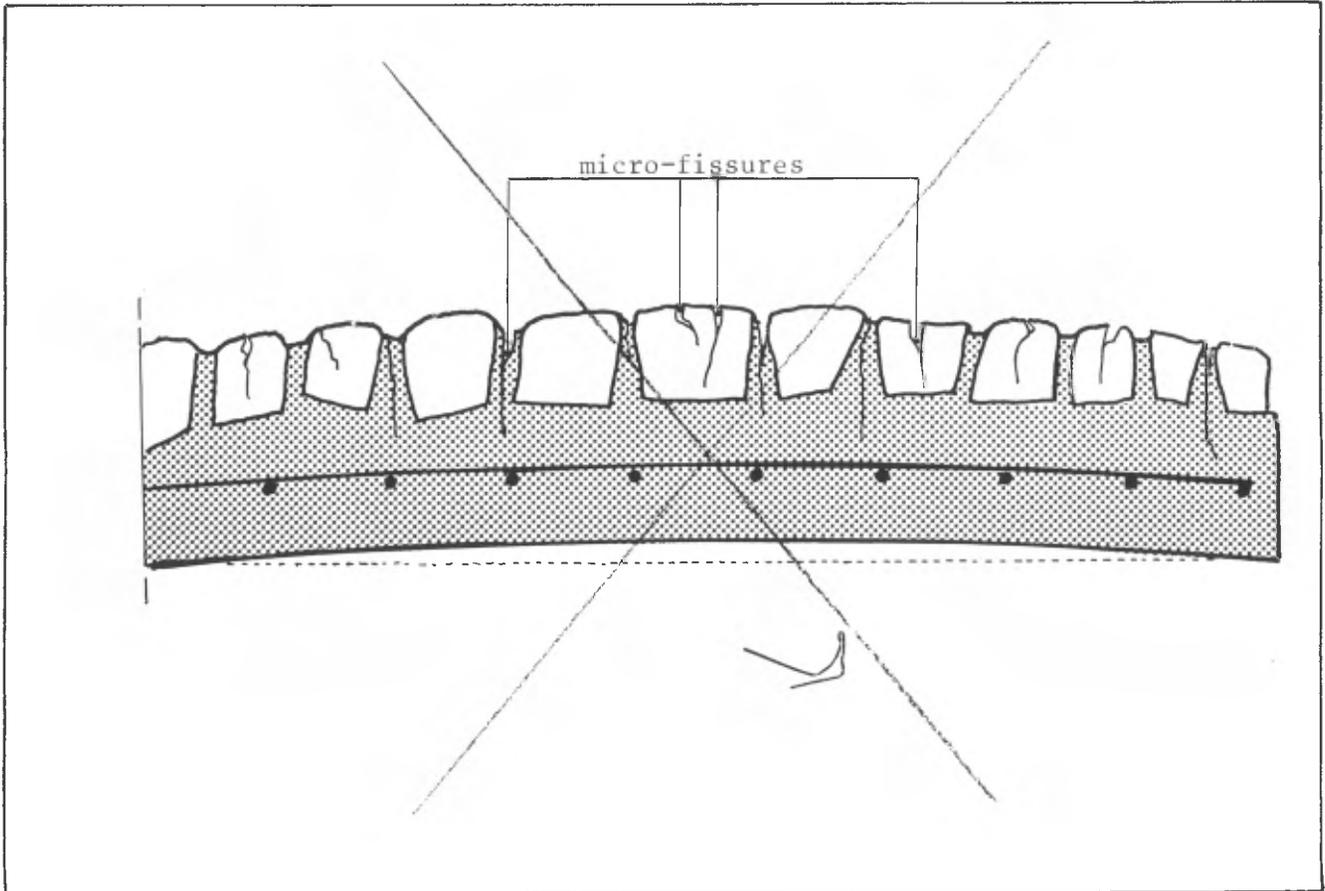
Exemple d'une dalle de béton qui se cintre lors de la prise du béton.
